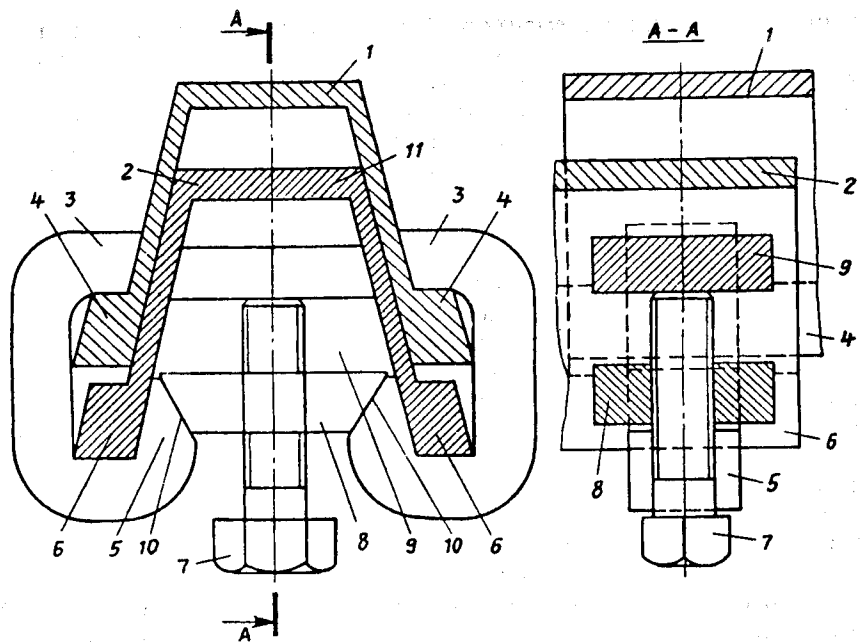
Клино-распорный узел конструкции ДГМИ
